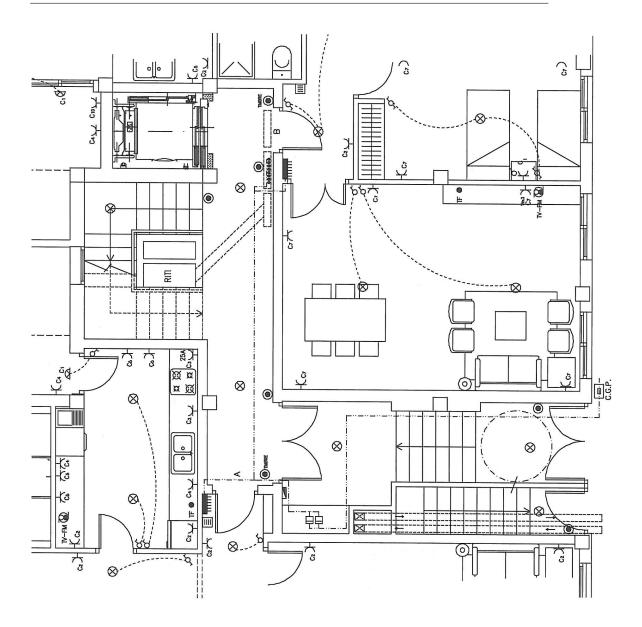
Posible dotación en planta baja de un edificio de viviendas para los servicios generales [12].
